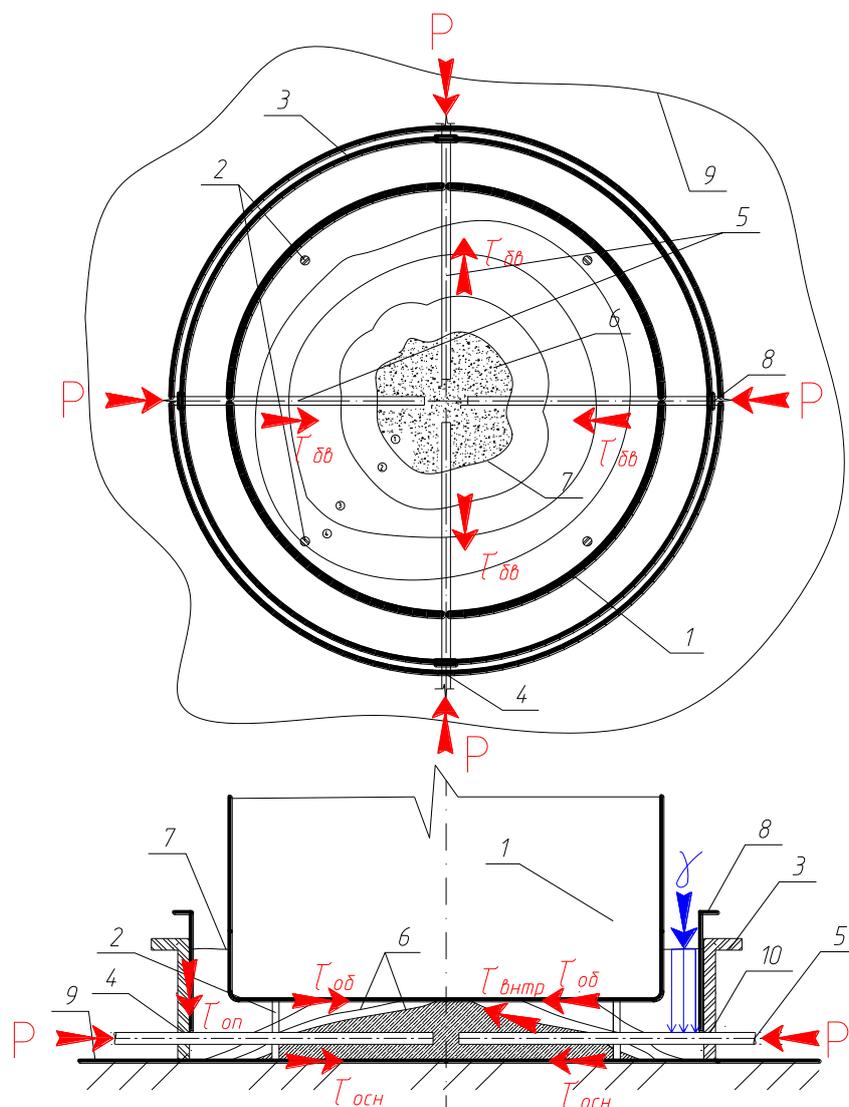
Схема бетонирования полости из центра нагнетательным методом (физическая модель): 1 – оборудование; 2 – опоры; 3 – опалубка; 4 – отверстия в опалубке под бетоноводы; 5 – бетоноводы; 6 – бетонная смесь; 7 – уровень бетонирования (подпора); 8 – заглушки; 9 – основание; 10 – уплотнитель.
